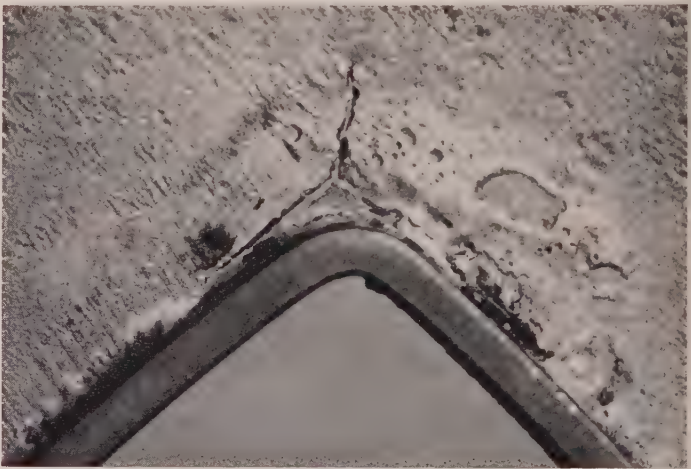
Eingerissenes Stegblech einer Rahmenecke
